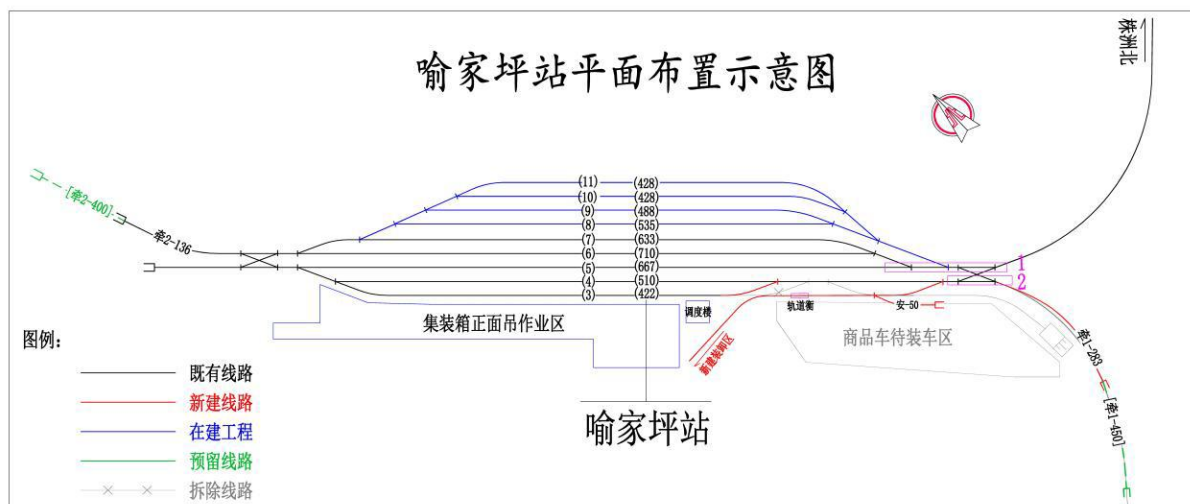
拆除既有 13 道接轨方案平面布置示意图
